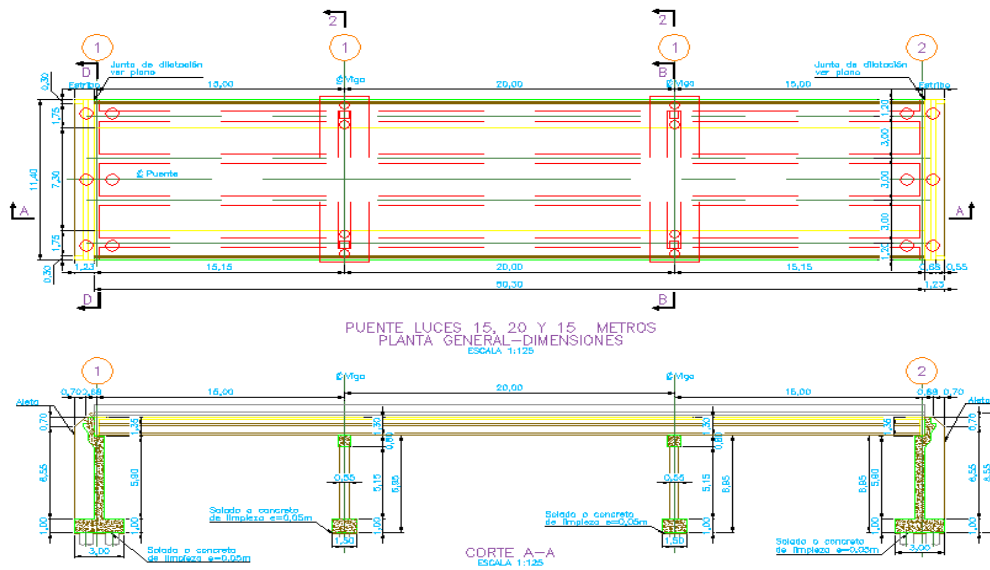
Sección Longitudinal en Planta y Corte – Puente 4
